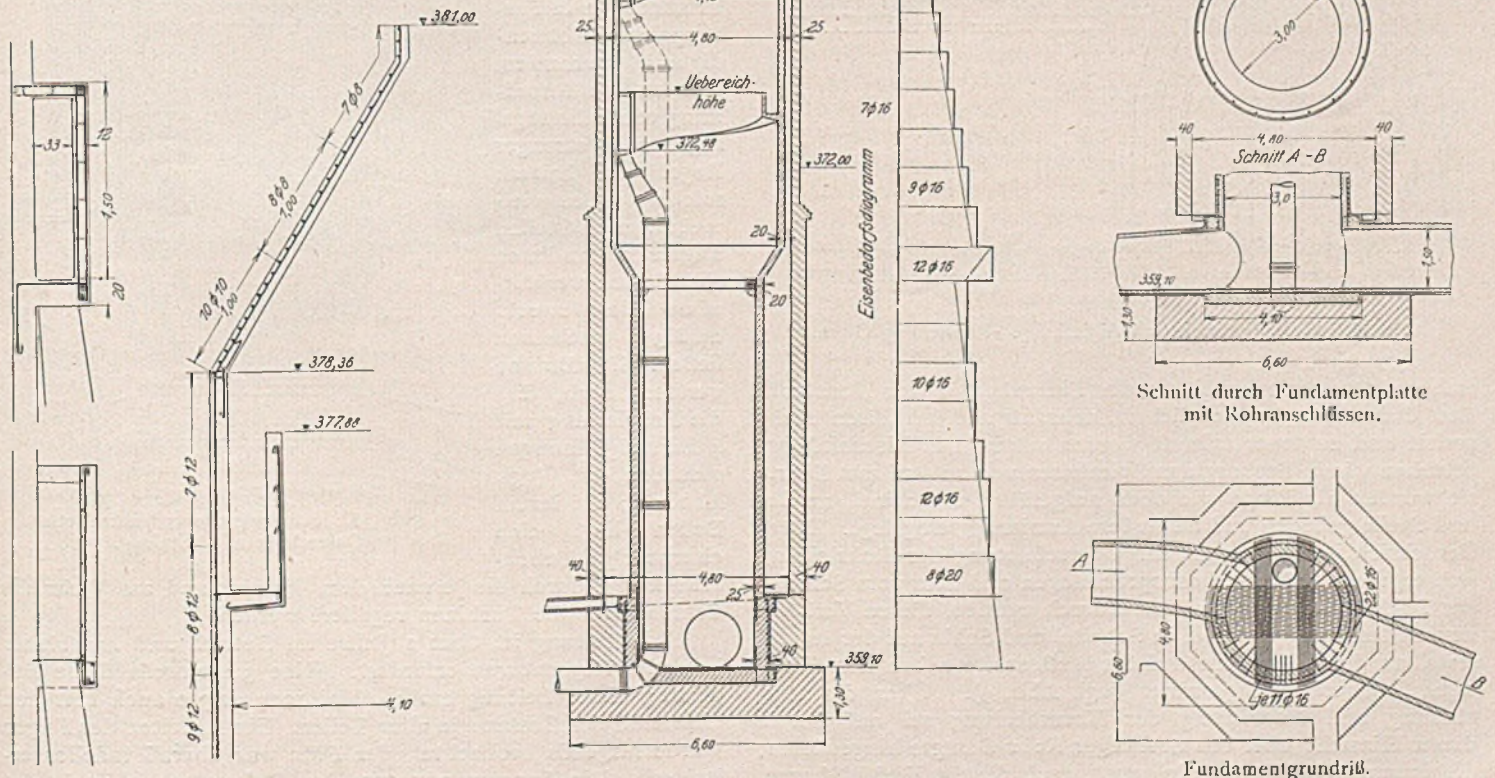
Druckausgleichturm mit Schnitten und Einzelheiten.
